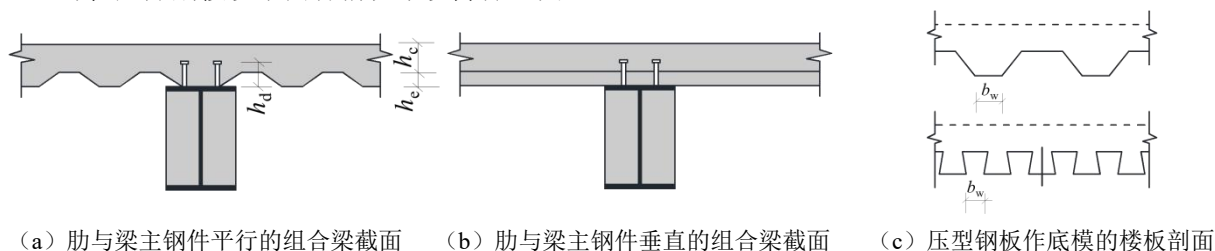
用压型钢板作混凝土翼板底模的组合梁
